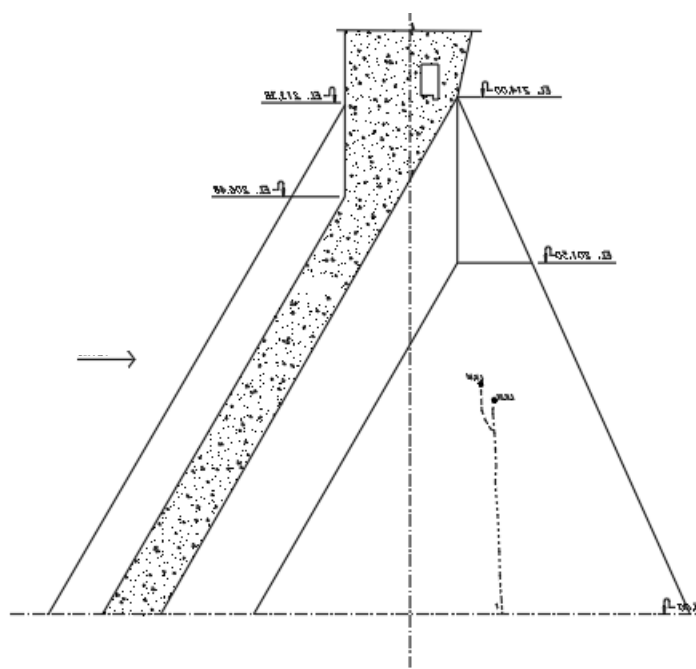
Mapeamento de fissuras – Bloco D38 – Face esquerda - Fonte: MENEZES e AKIO [49]
